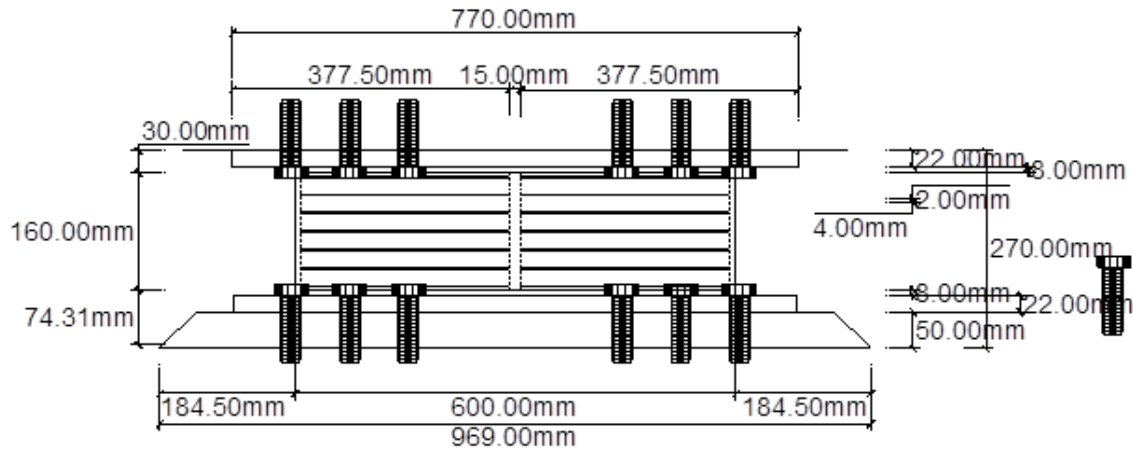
Dispositivo aislador HL060X4R - vista en elevación
